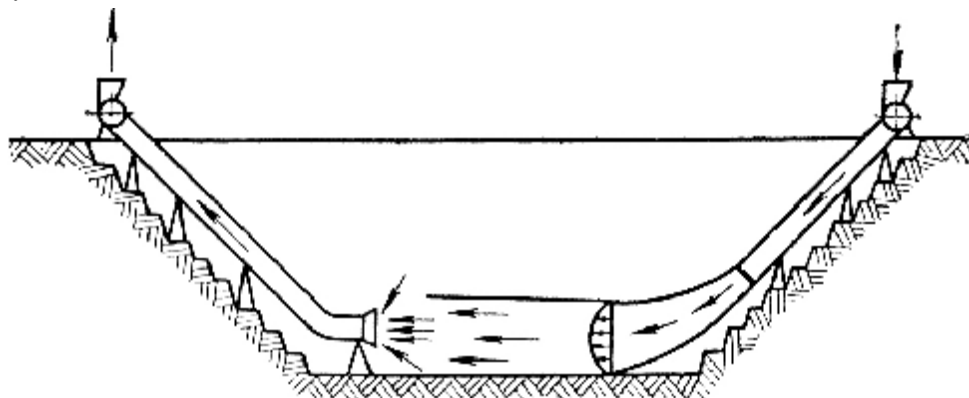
Схема нагнетательно-всасывающей вентиляции вентиляторными установками с применением трубопроводов.
